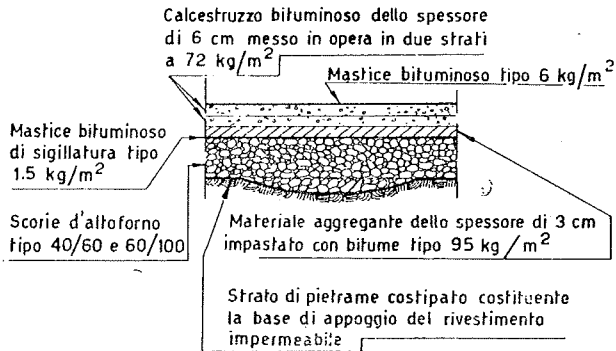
Sezione del rivestimento impermeabile sul fondo del serbatoio.
